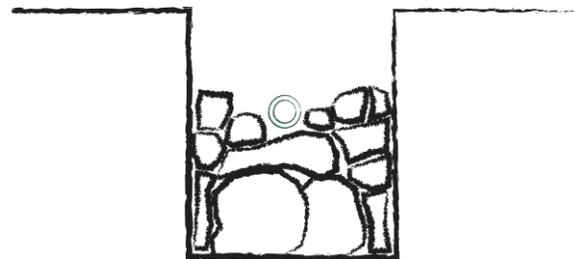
Preparación para instalación hidráulica para conexión de cámaras de filtrado. Fuente: Elaboración propia.
